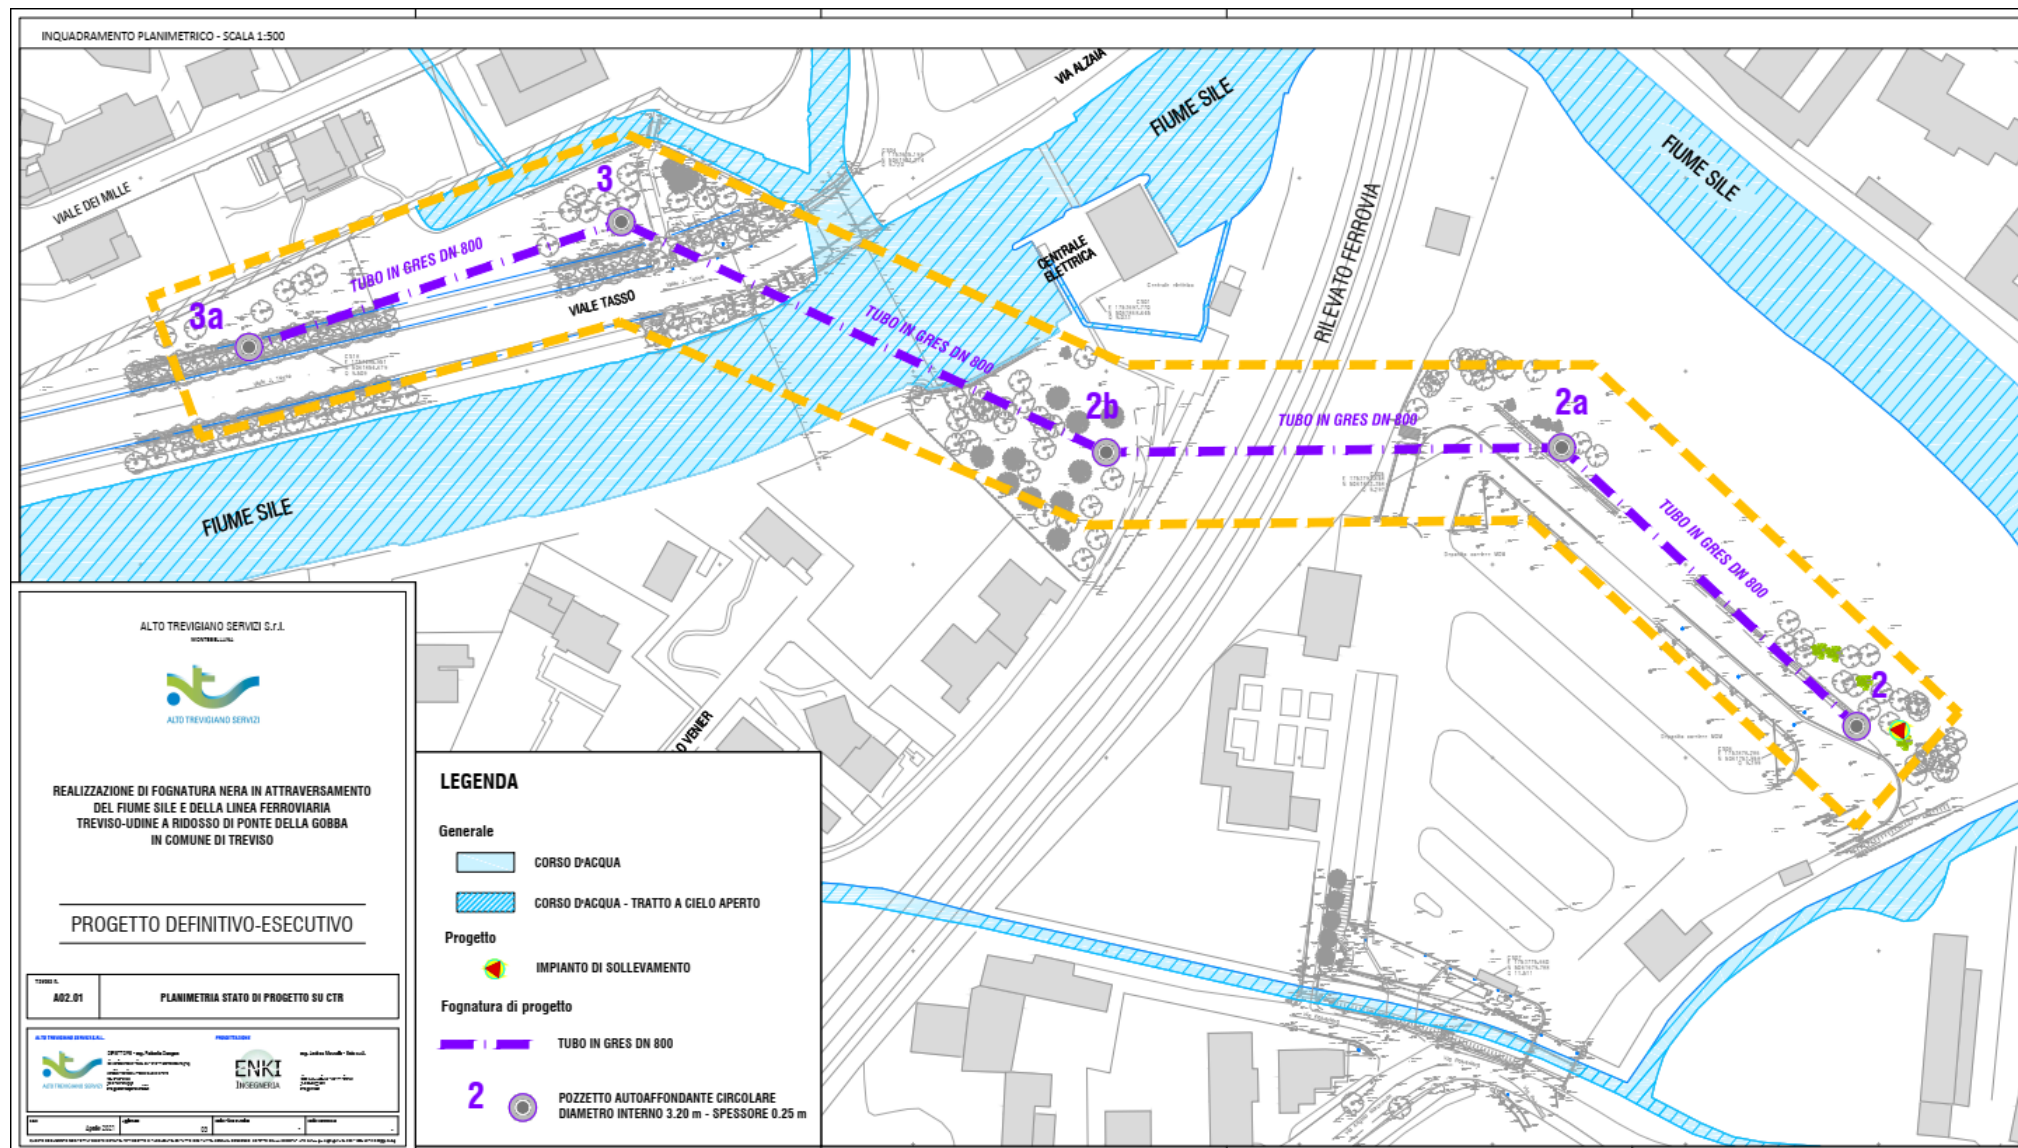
B : Estratto planimetrico giaciture condotte microtunnelling
